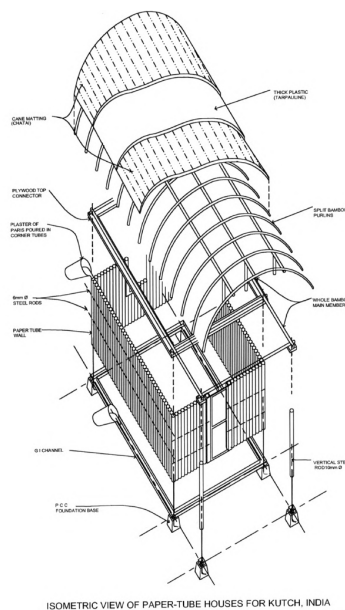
Axonometría constructiva de la Paper Log House en India. Fuente: [http://sandrahofmeister.eu/images/pdf/2016\\_07\\_DAMn57\\_SHIGERU\\_BAN1.pdf](http://sandrahofmeister.eu/images/pdf/2016_07_DAMn57_SHIGERU_BAN1.pdf)
